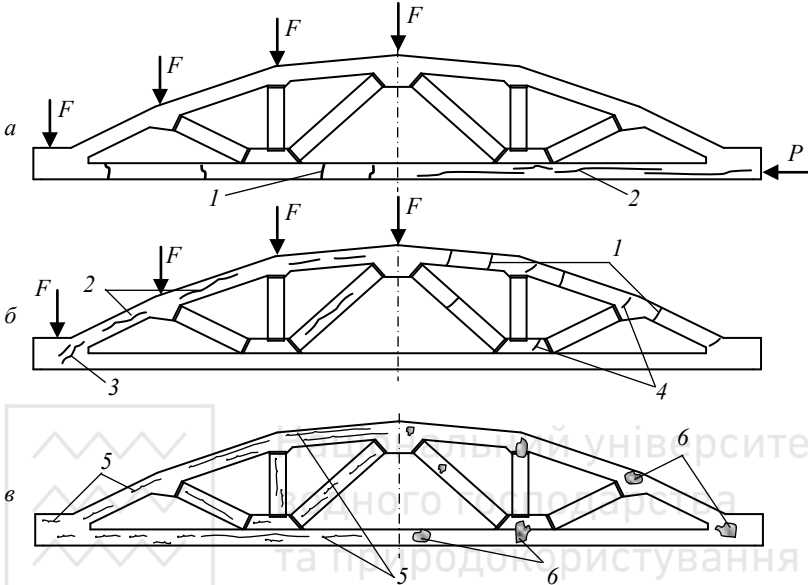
Схеми пошкоджень залізобетонних ферм:
